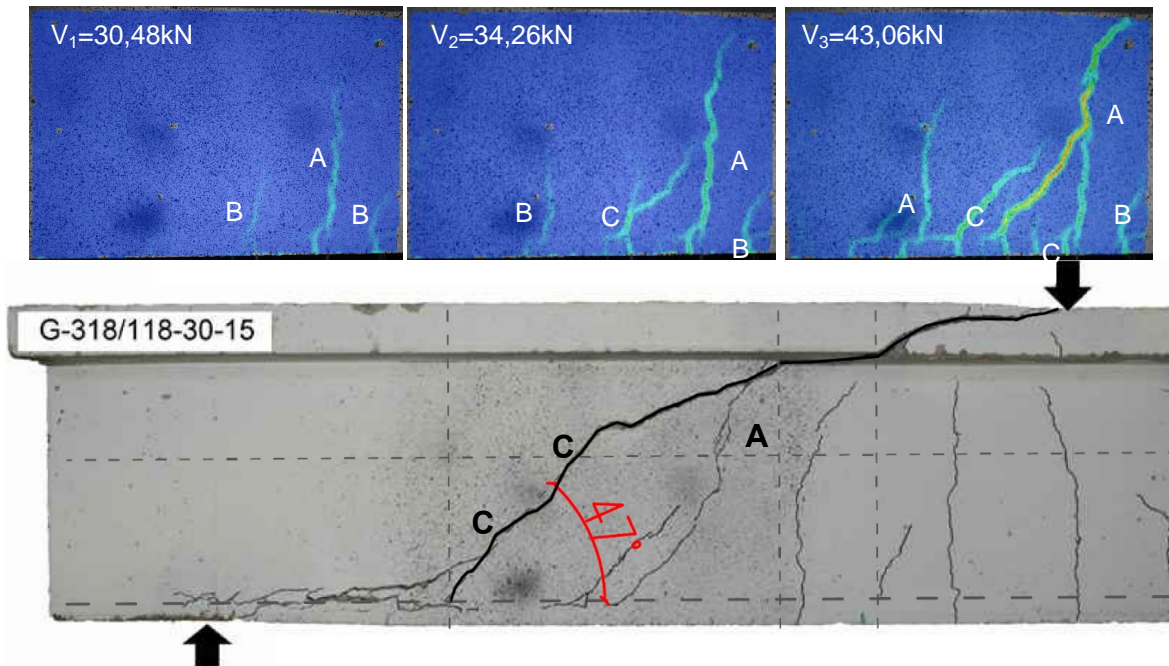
Przykład zniszczenia poprzez połączenie rysy typu „A”, „C” i „E”
